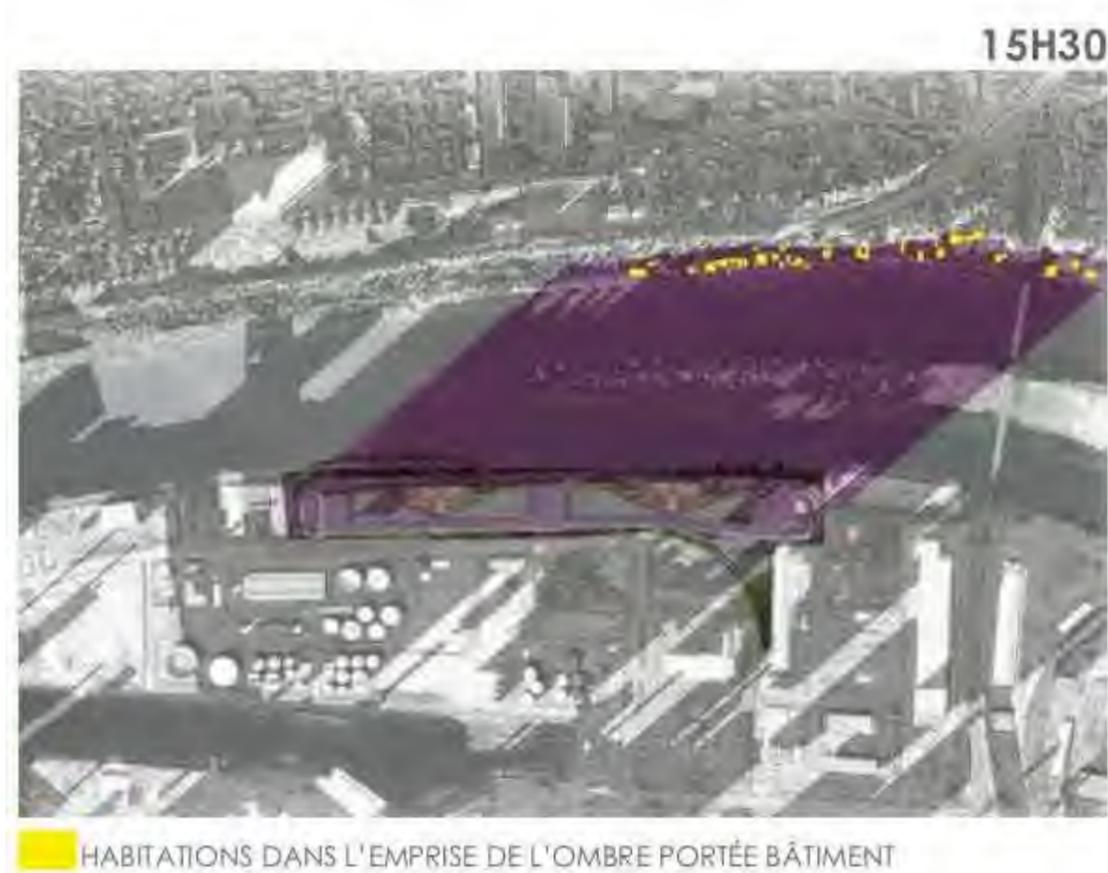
Plans de masse d'ensoleillement (Source : A26)
